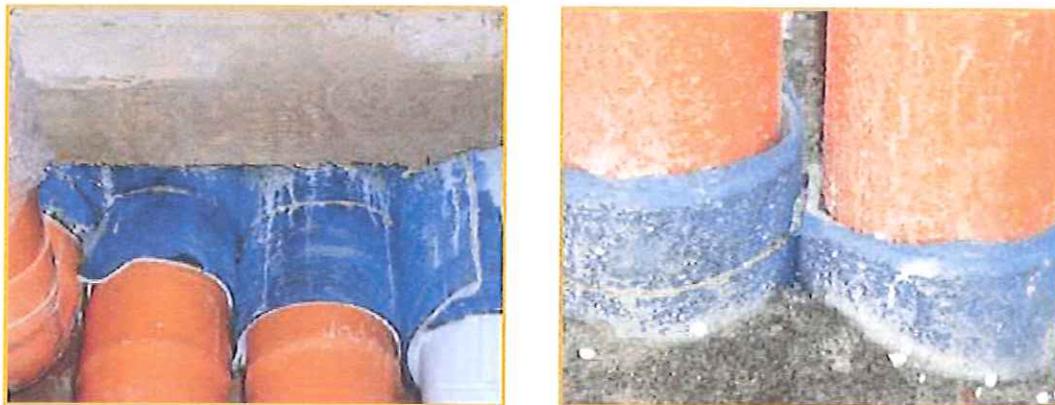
Rivestimento degli impianti nel passaggio attraverso i solai
